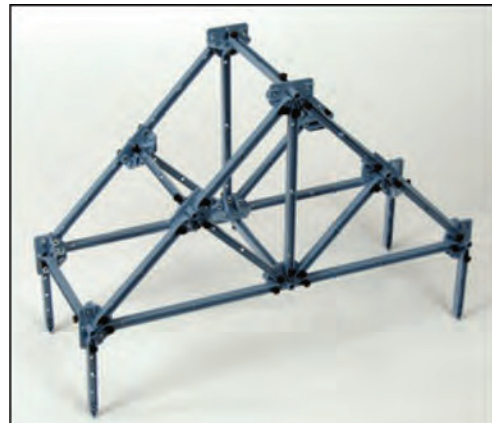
Aufbau eines einfachen Dachtragwerkes
